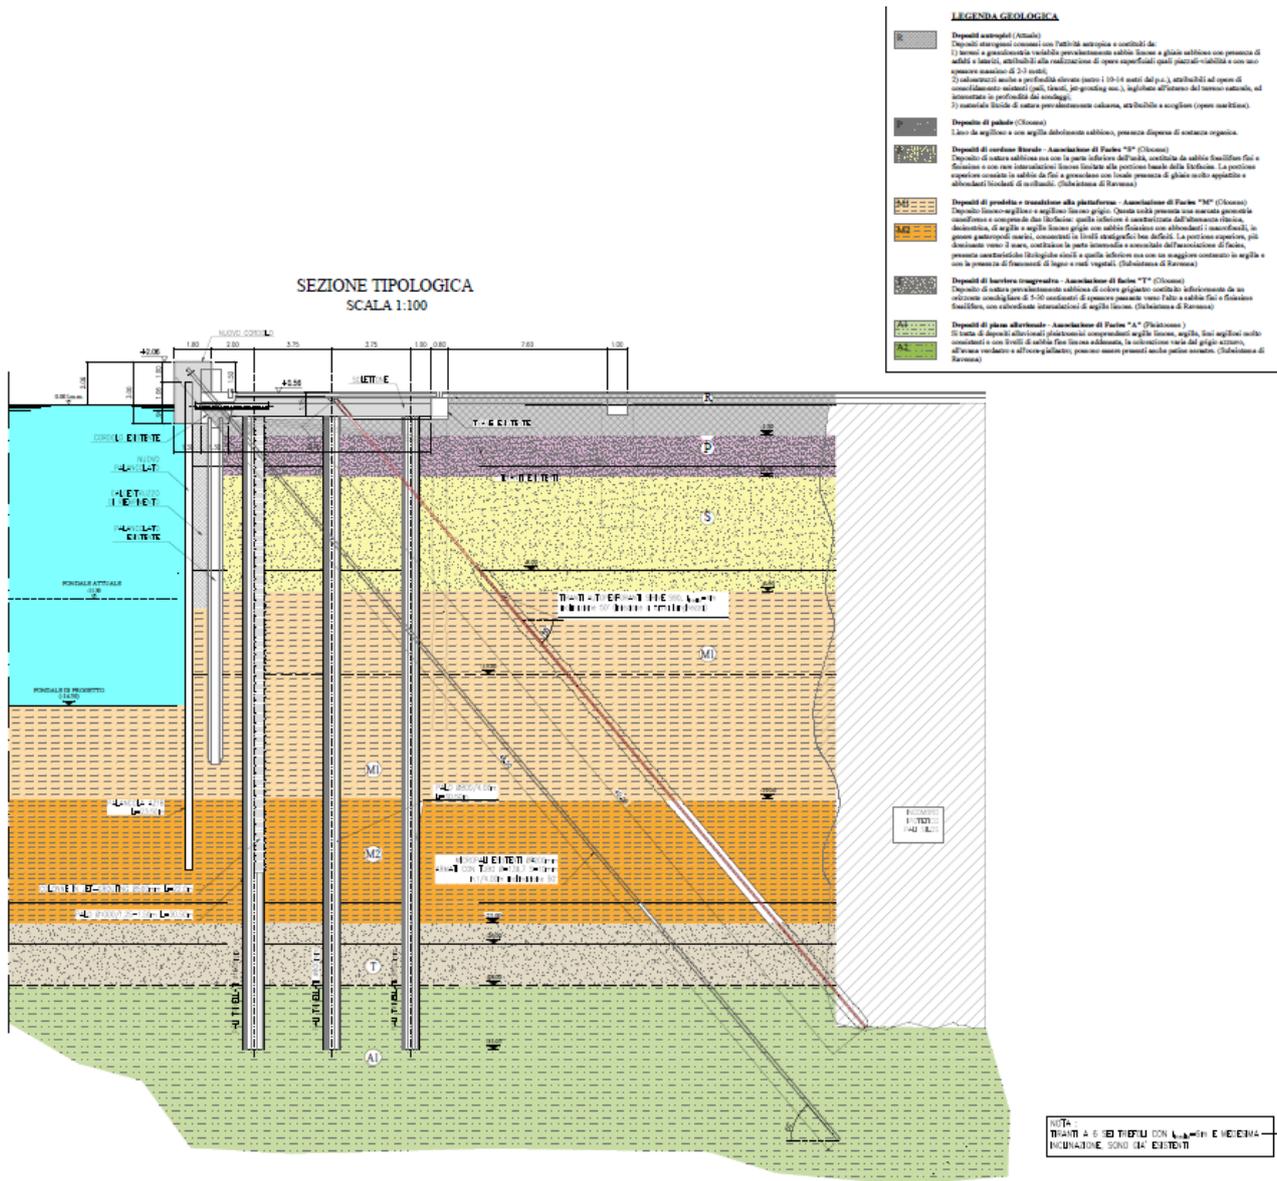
Bunge Nord – Progetto Esecutivo – Sezione intervento
